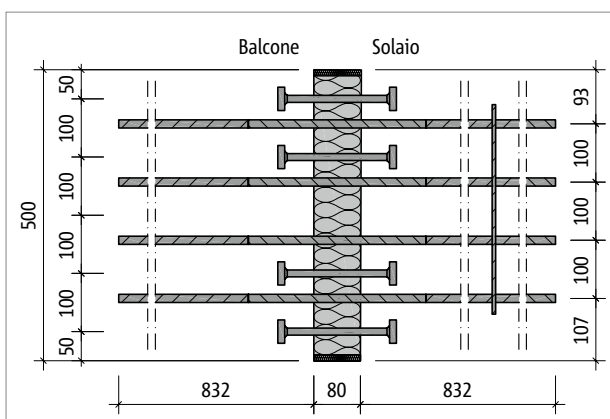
Schöck Isokorb® T tipo QP-V10: pianta del prodotto
